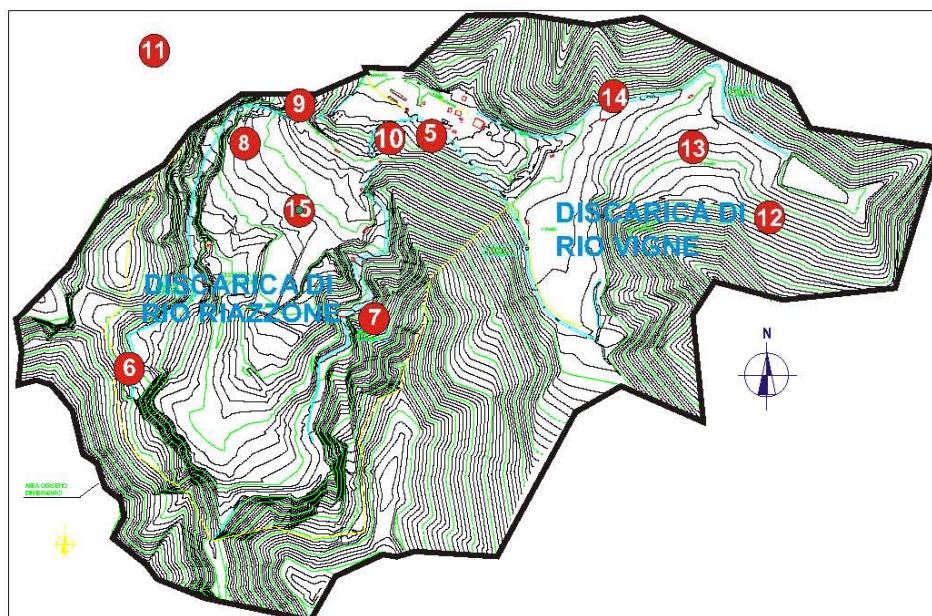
Figura VIII. Ubicazione e dettaglio delle attività presso la Stazione 8 nuova
